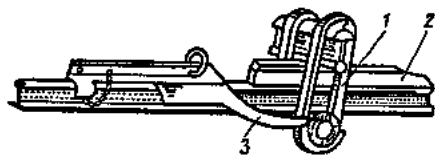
Общий вид приспособления для установки и снятия клина ударного разгонного прибора:
